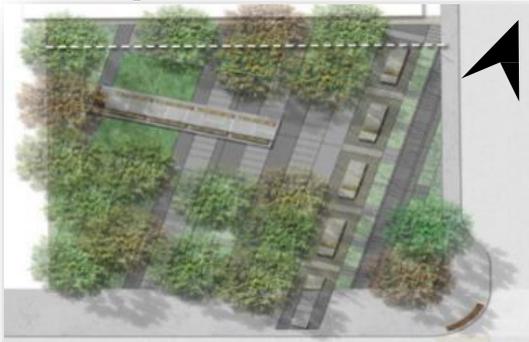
plan de masse : PLAN D'URBANISME DE MONTRÉAL
